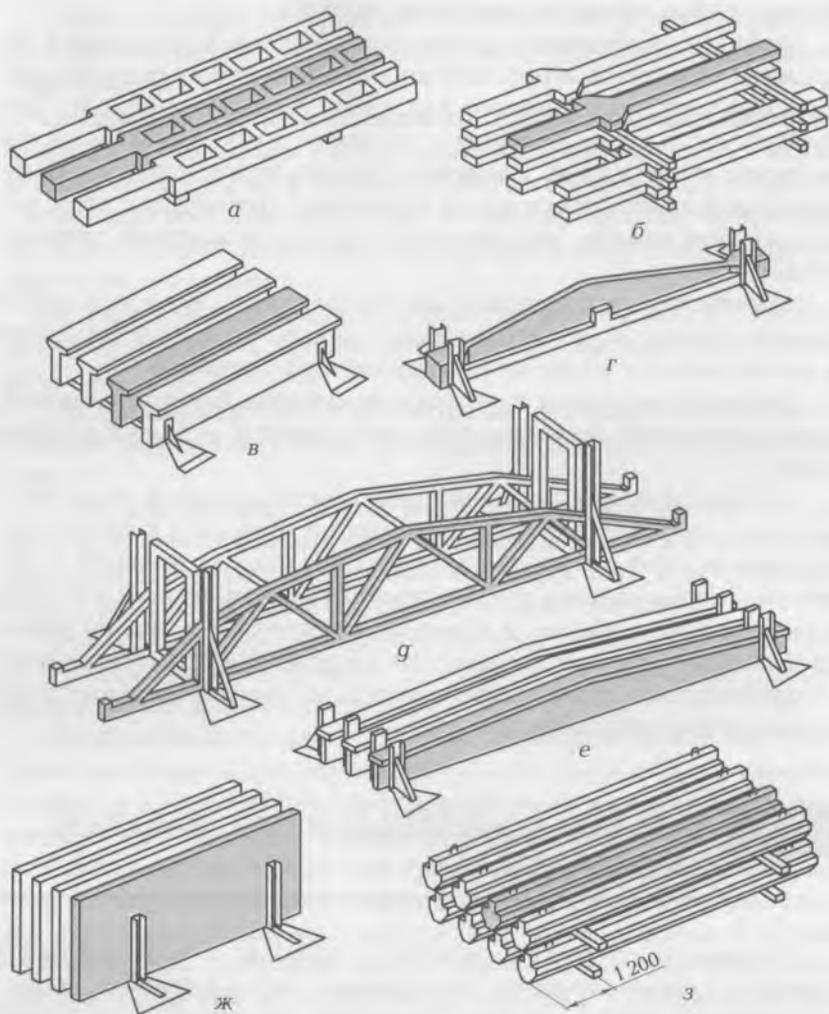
Складирование железобетонных конструкций промышленных зданий:
